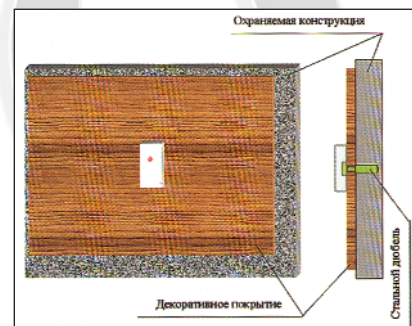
Пример установки извещателя на конструкцию с декоративным покрытием
